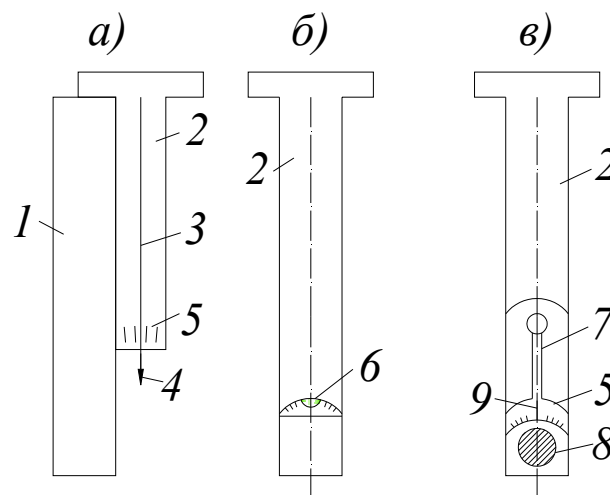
Висок-рейки: а) з нижнім виском; б) з рівнем; в) з маятниковим виском. 2-планка виска-рейки; 3-нитка виска; 4-вантаж виска; 5-шкала; 6-циліндричний рівень; 7-штанга маятникового виска; 8-вантаж; 9-стрілка
